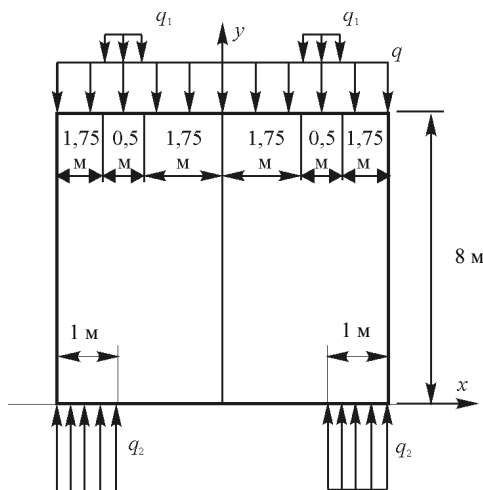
Окончательный вариант расчётной схемы балки-стенки
